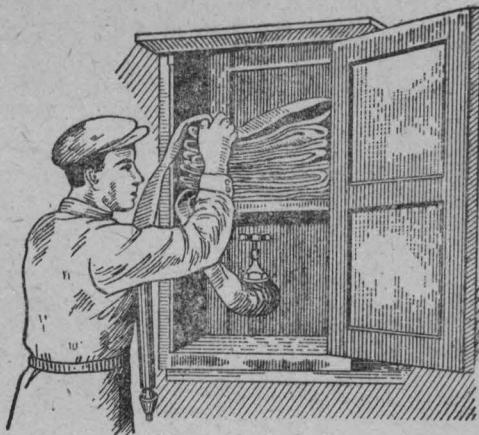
Оборудование пожарного крана внутреннего водопровода.
